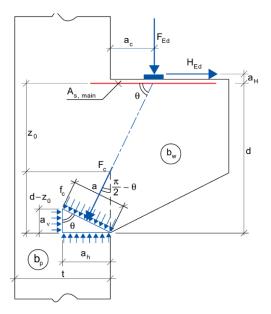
К определению угла наклона сжатого бетонного подкоса
